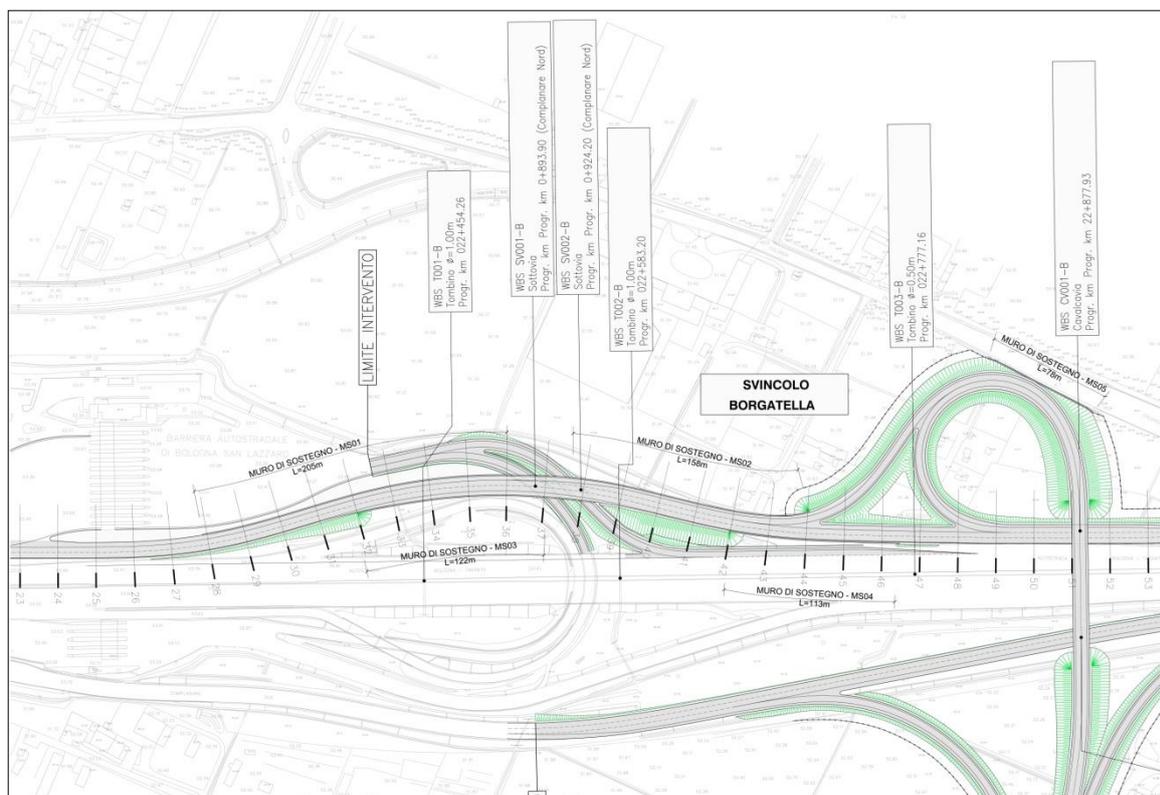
Stralcio planimetrico - Svincolo Borgatella
